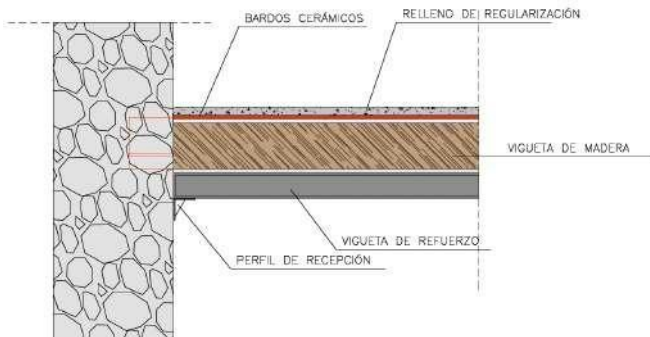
Perfil de refuerzo bajo vigueta existente. Alternativa perfil UPN. Fuente propia
